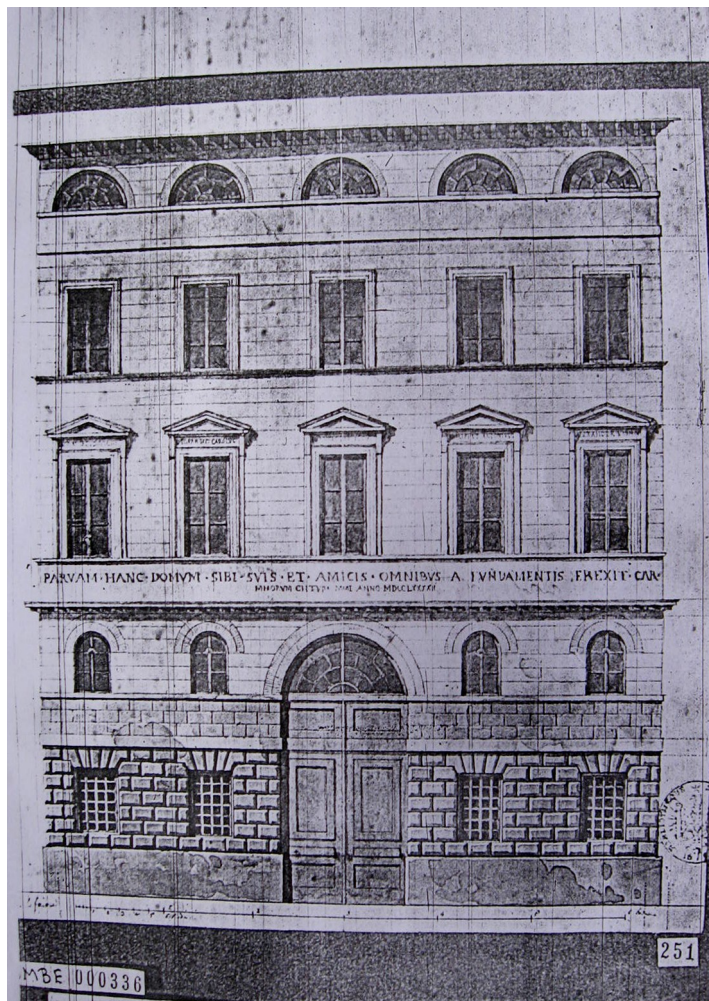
Pierre-Adrien Pâris : « Élévation de la façade d'une maison particulière au Havre » © BM Besançon vol-453 n 494 Façade de la maison Pâris
